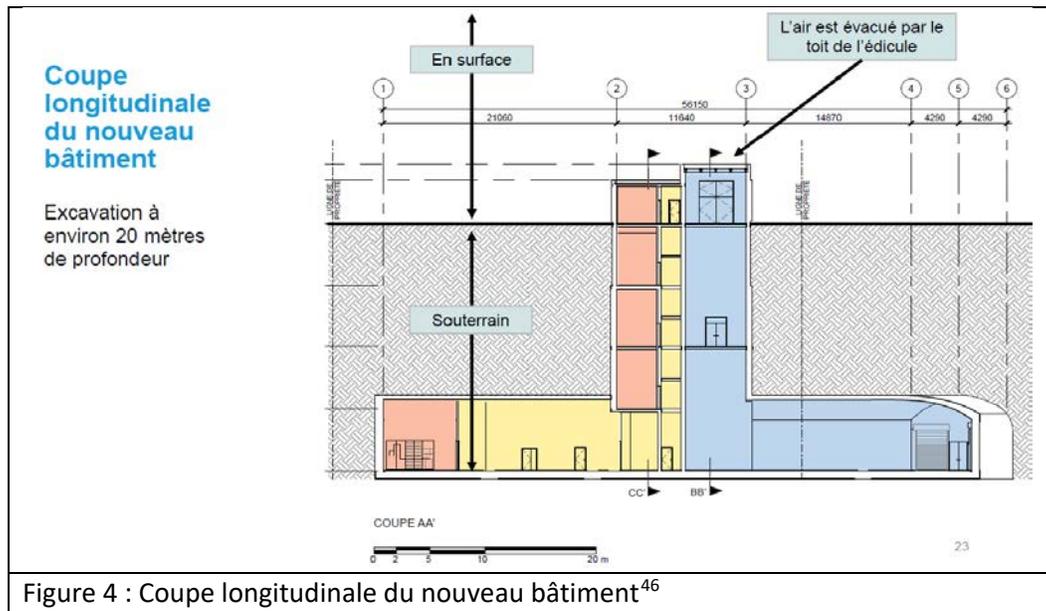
Coupe longitudinale du nouveau bâtiment⁴⁶
